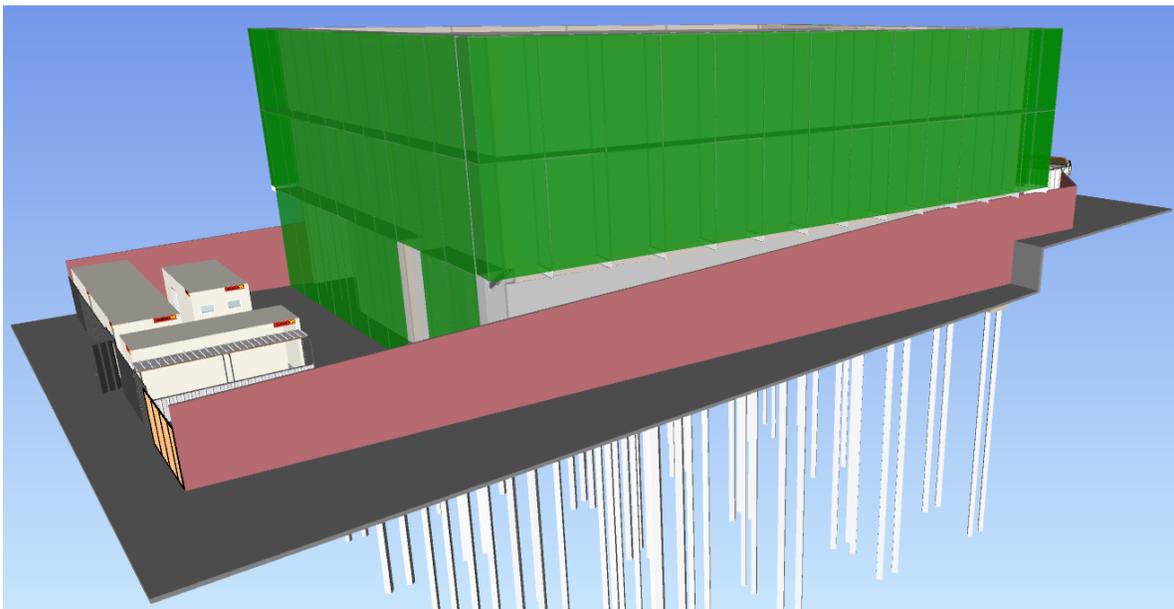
Simulação Navisworks: execução de alvenarias térreo e 2º pavimento
